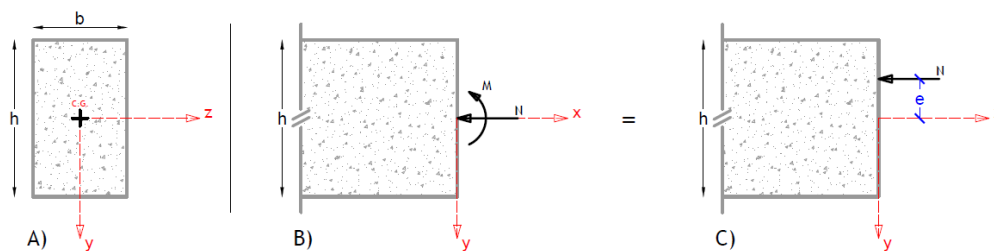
A) Secção transversal da viga. B) Esforços na secção do meio vão da viga aplicados no centro de gravidade da secção. C) Esforço normal de compressão aplicado excentricamente em relação ao centro de gravidade da viga e equivalente a B).
